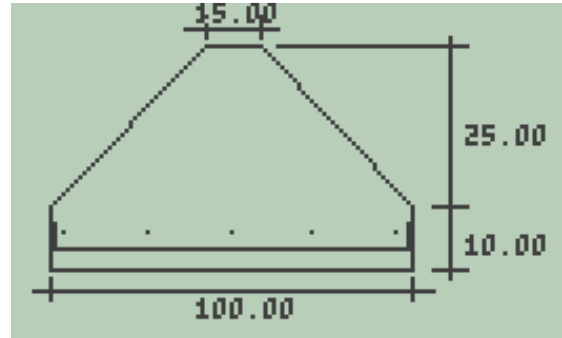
Sapata corrida sem viga de rigidez - Detalhamento da seção transversal.
